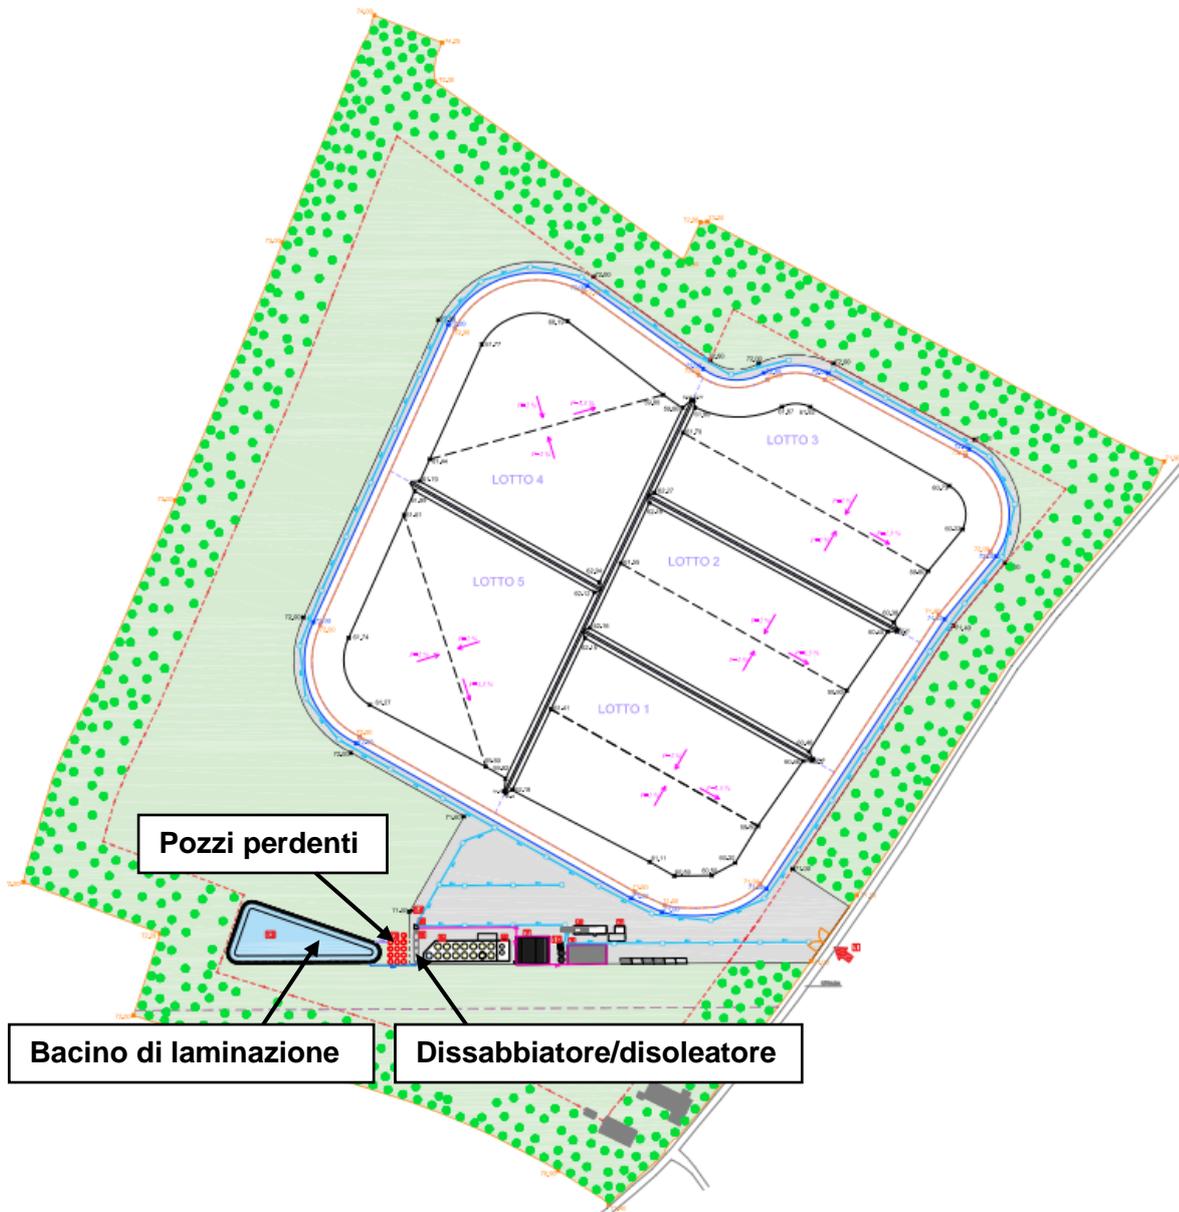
Planimetria reti e opere di invarianza idraulica in fase gestionale
